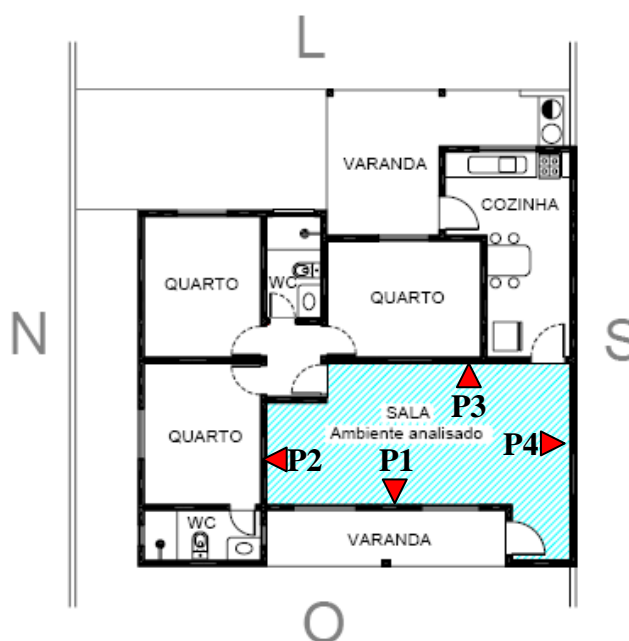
Planta baixa da residência 01 – P1: parede 1; P2: parede 2; P3: parede 3; P4: parede 4
